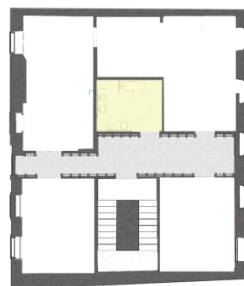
Planta de pormenor corredor com casa de banho, com mobiliário, criação do autor.
